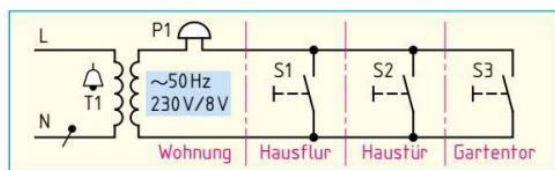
Hausrufanlage mit drei Betätigungsstellen
